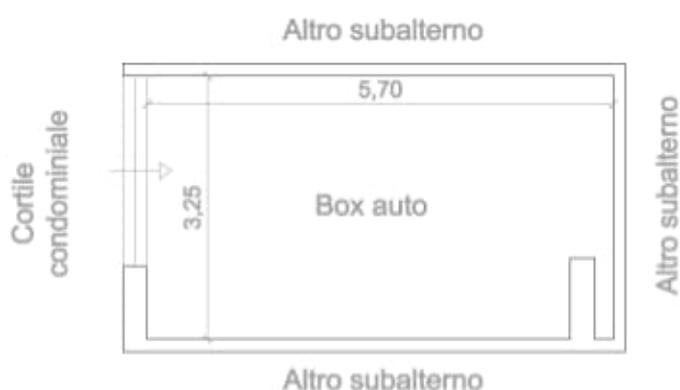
Planimetria del box auto oggetto di pignoramento, con individuazione dei locali
